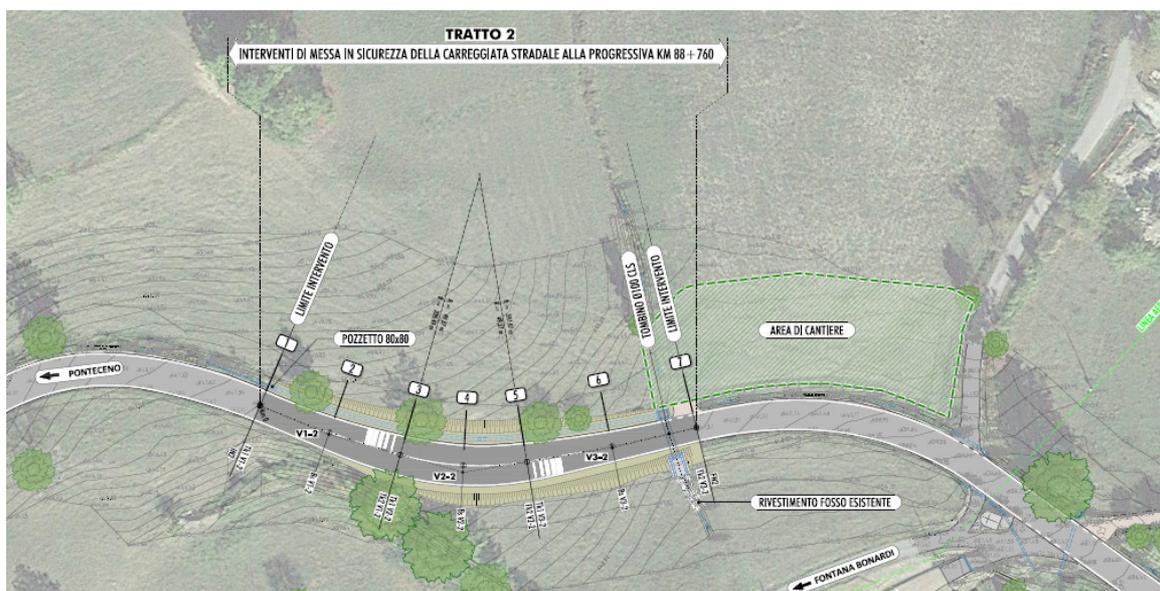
INTERVENTO TRATTO 2 – STRALCIO PLANIMETRICO
